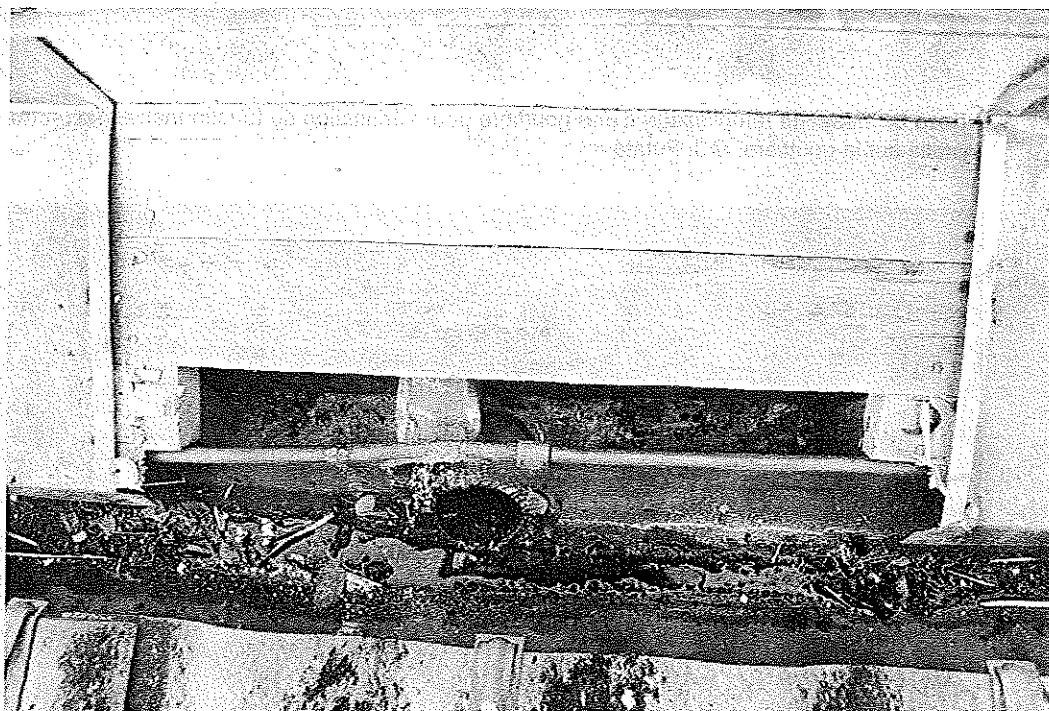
Démontage de l'ouvrage rapporté au droit d'un dispositif de trop-plein débouchant en façade.
